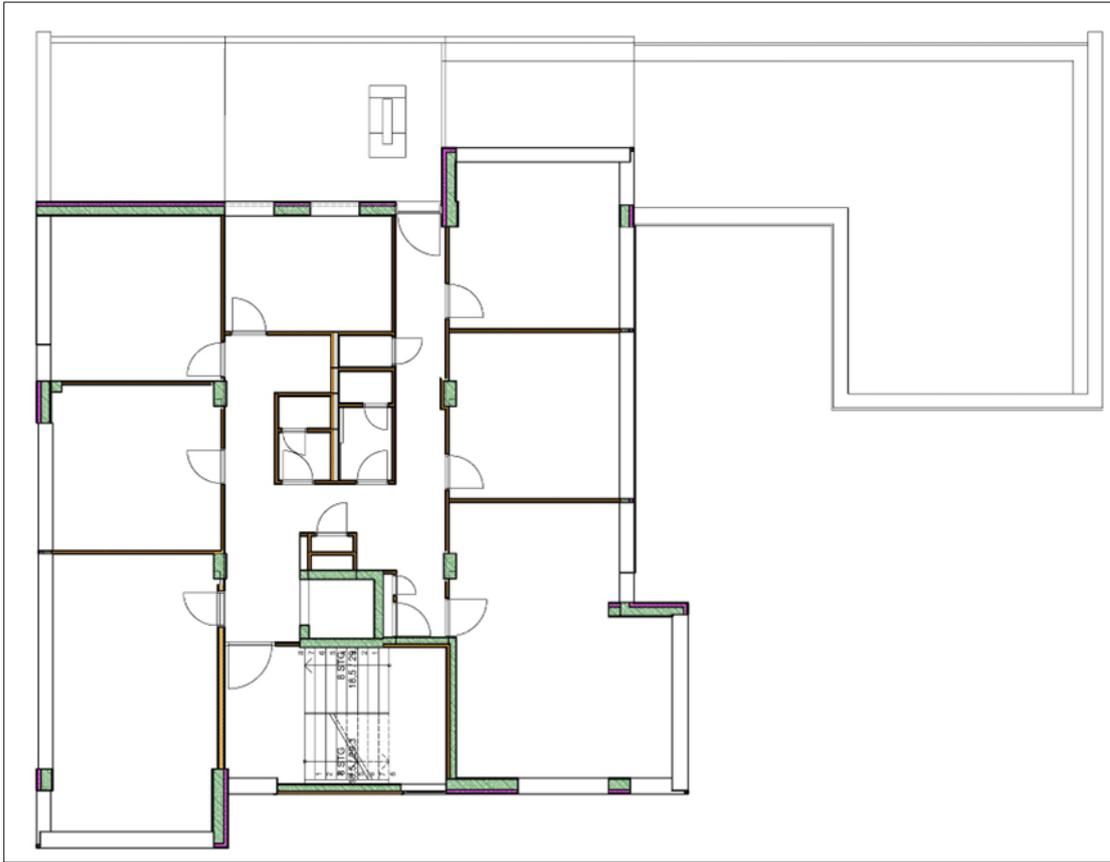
Fallbeispiel Grundriss OG3
